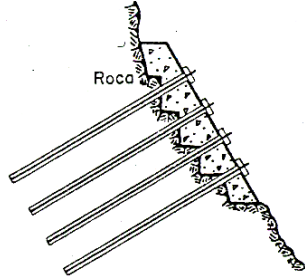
Anclaje en la cimentación de una presa (CFE, 1981).
